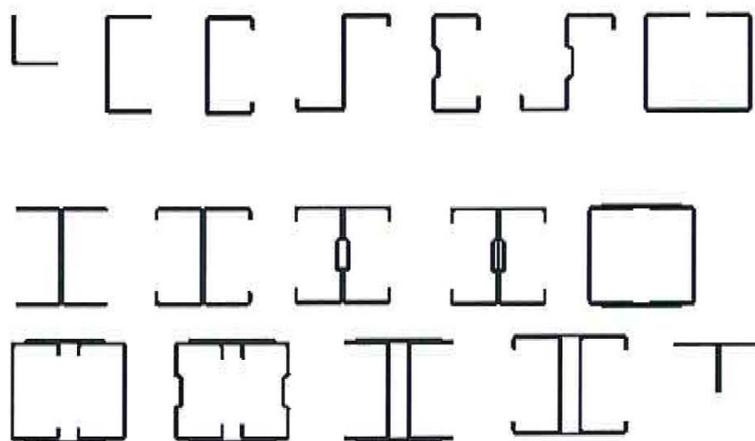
Типовые формы профилей и сечений конструкций из ЛСТК
